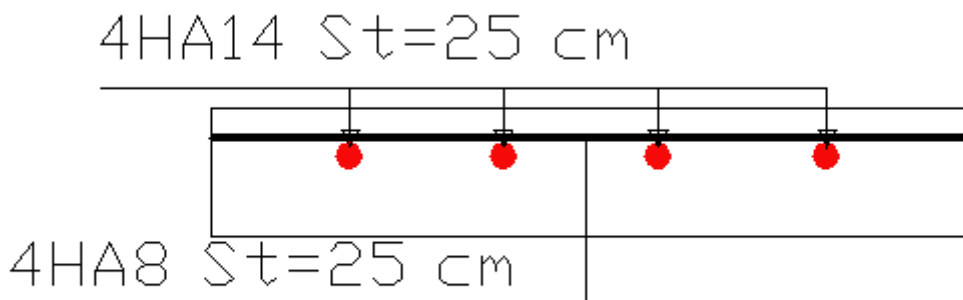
Schéma de ferrailage de palier intermédiaire (dalle sur un seul appui)
